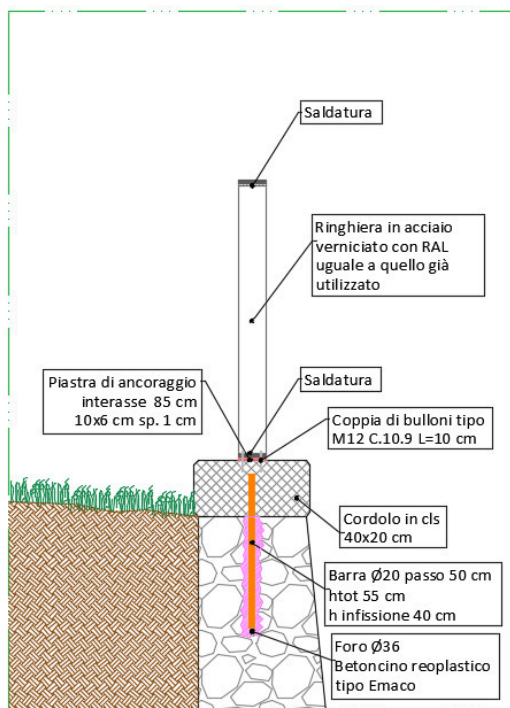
Parapetto ad Ovest del piazzale Belvedere (Cordolo 2)
